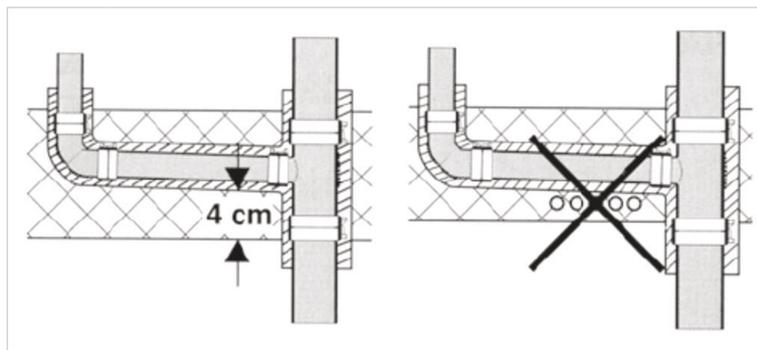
Posa delle tubazione nel calcestruzzo.
